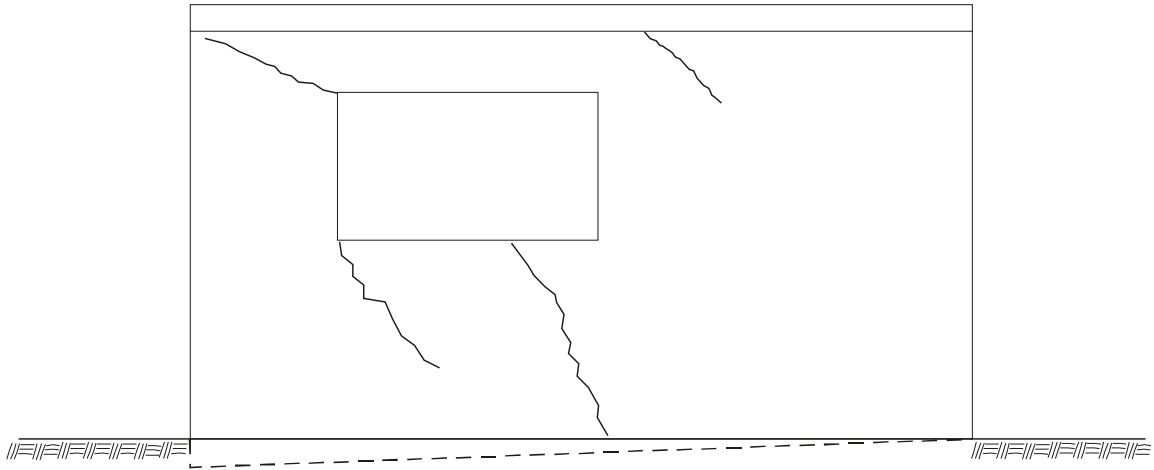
Fissuras inclinadas causadas por recalques diferenciais nas fundações (heterogeneidade do solo)
